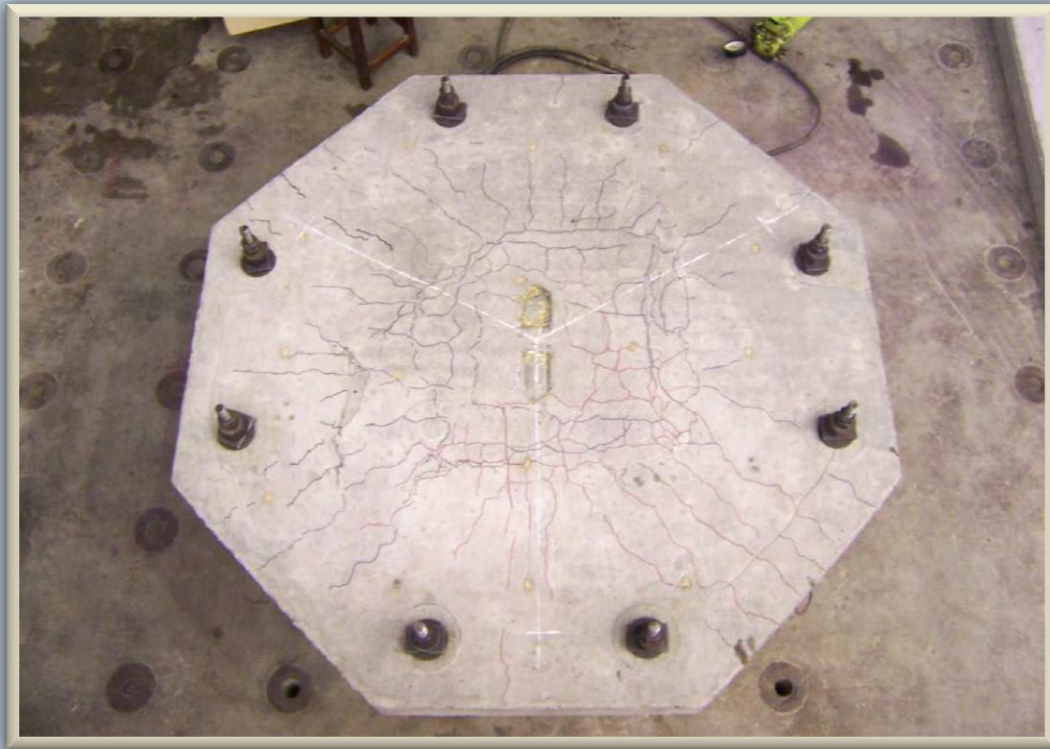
d.2-1.1) Configuración de agrietamiento y falla en planta y elevación, del bloque de unión losa-columna, al concluir el ensayo.
